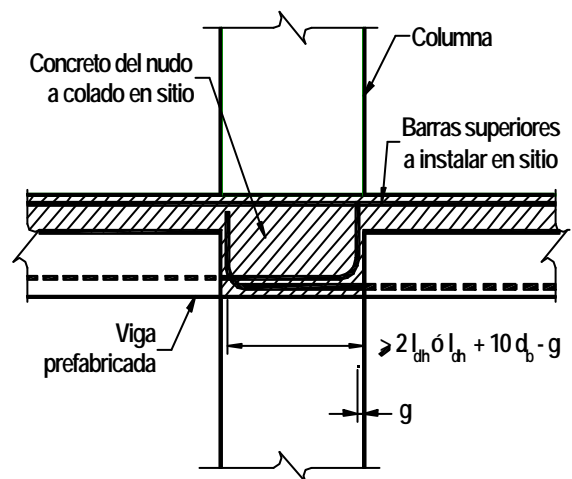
Conexión viga-columna (Guidelines, 1991)
